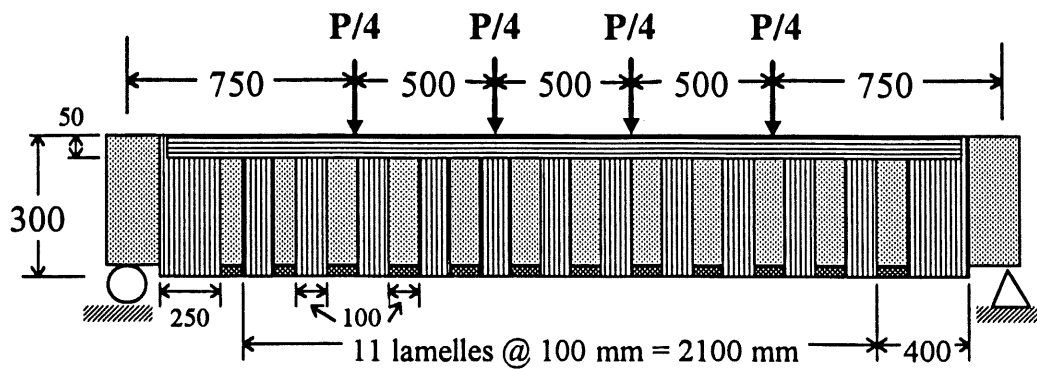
Poutre P3 avec lamelles en U équidistantes
